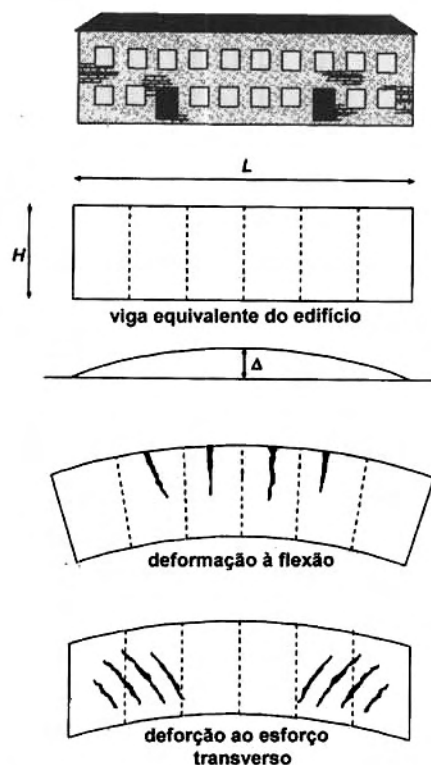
Idealização de um edifício por uma viga parede equivalente. Fissuras em flexão e corte (Cost C7, 2003).
